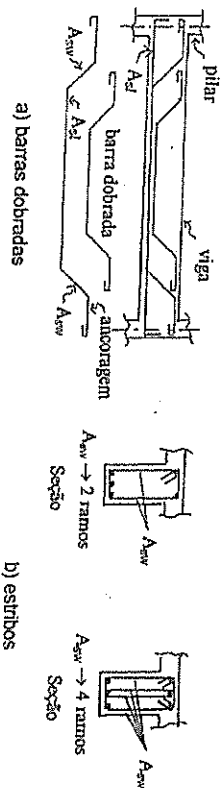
Área  $A_{sw}$  da seção transversal de armadura para barras dobradas e estribos
